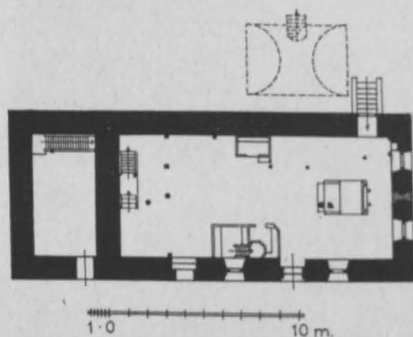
Drahnsdorf. Grundriß der Kirche.
